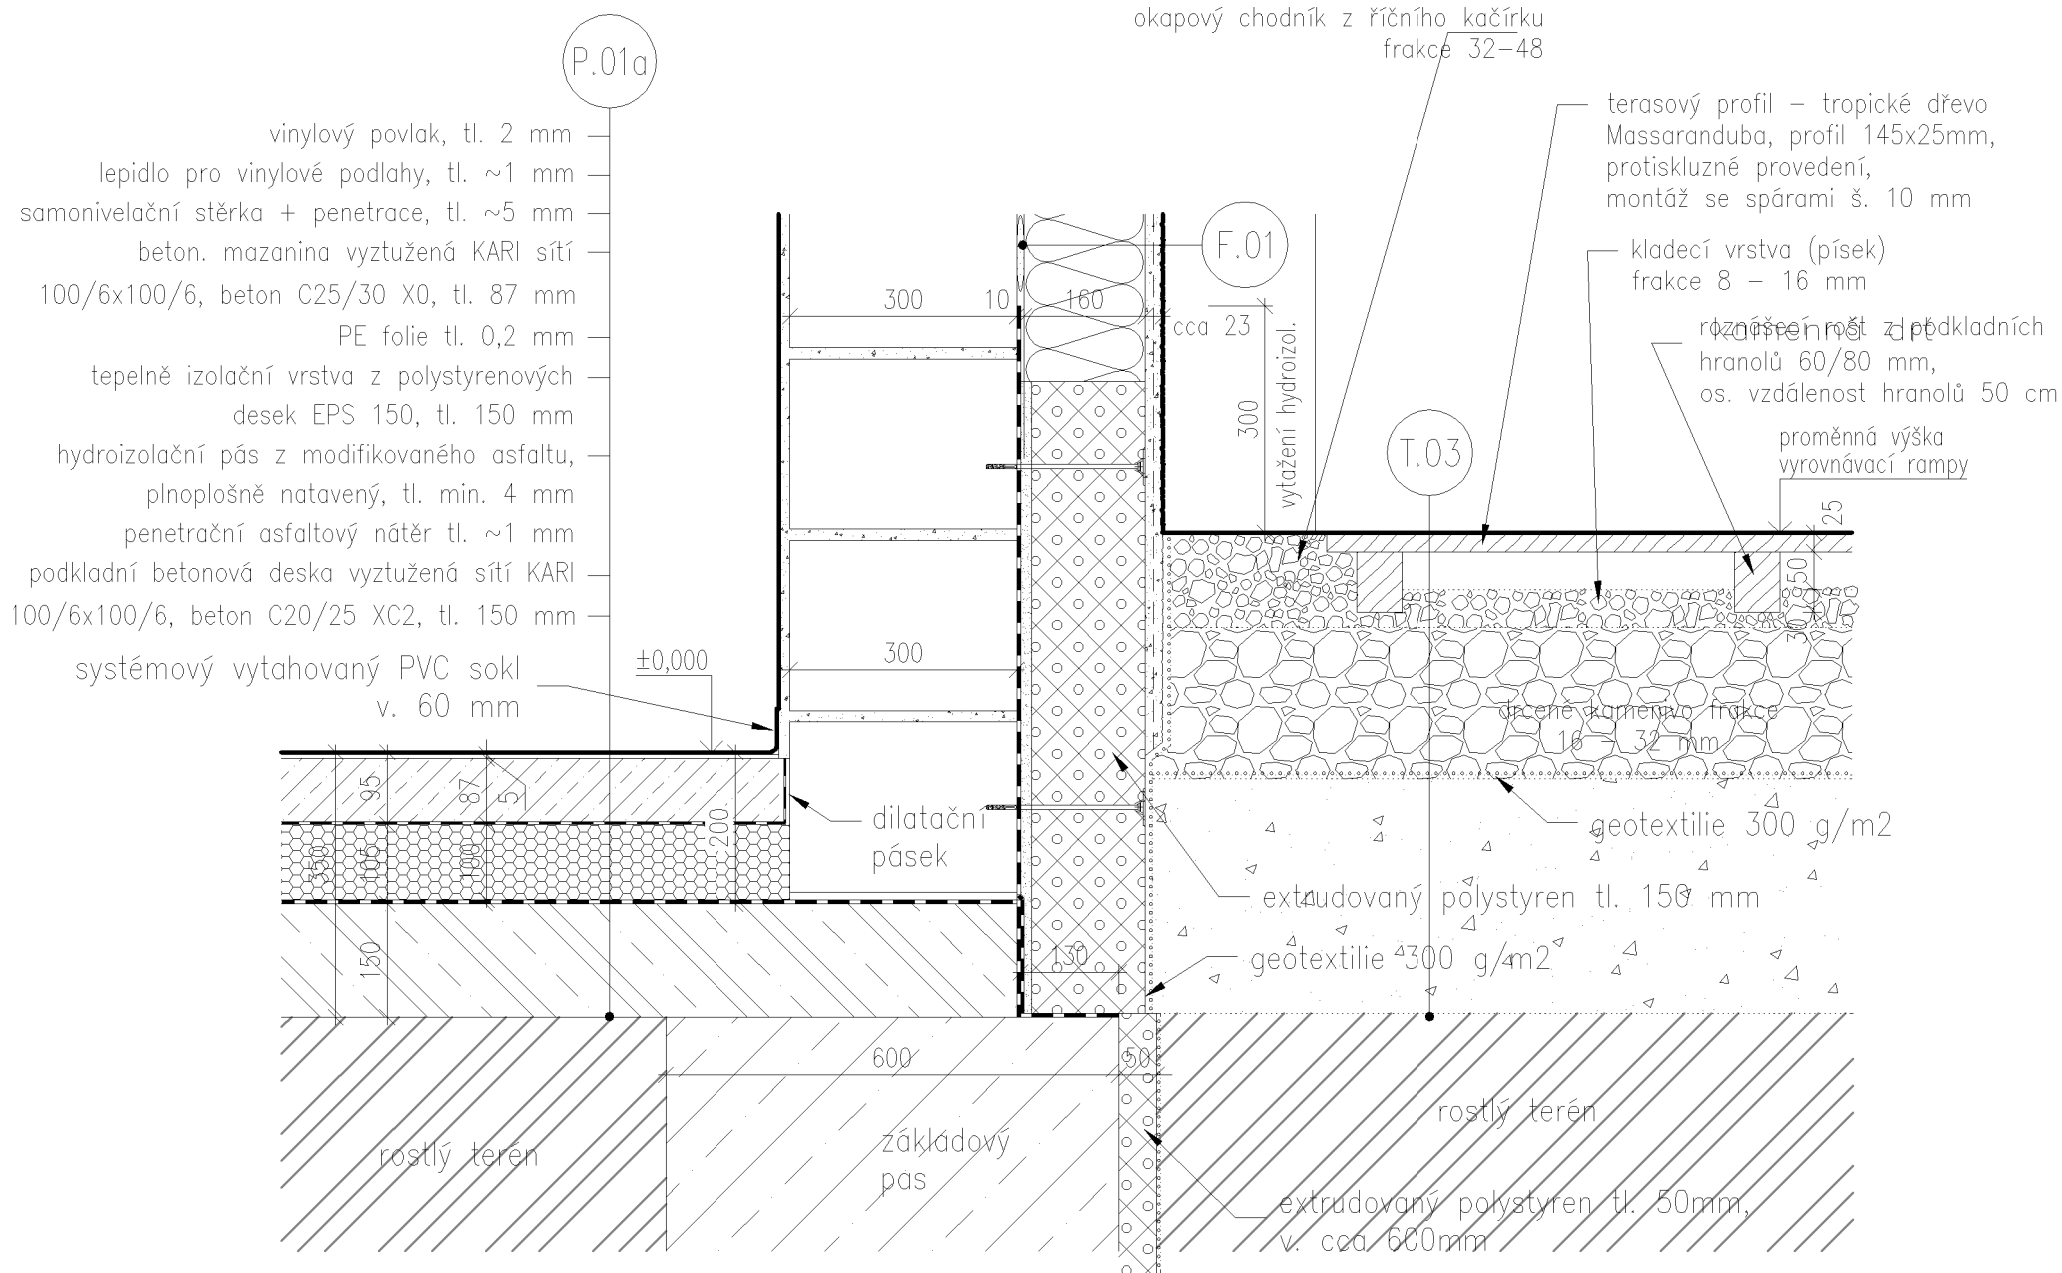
detail soklu - sokl zateplený / průběžný
